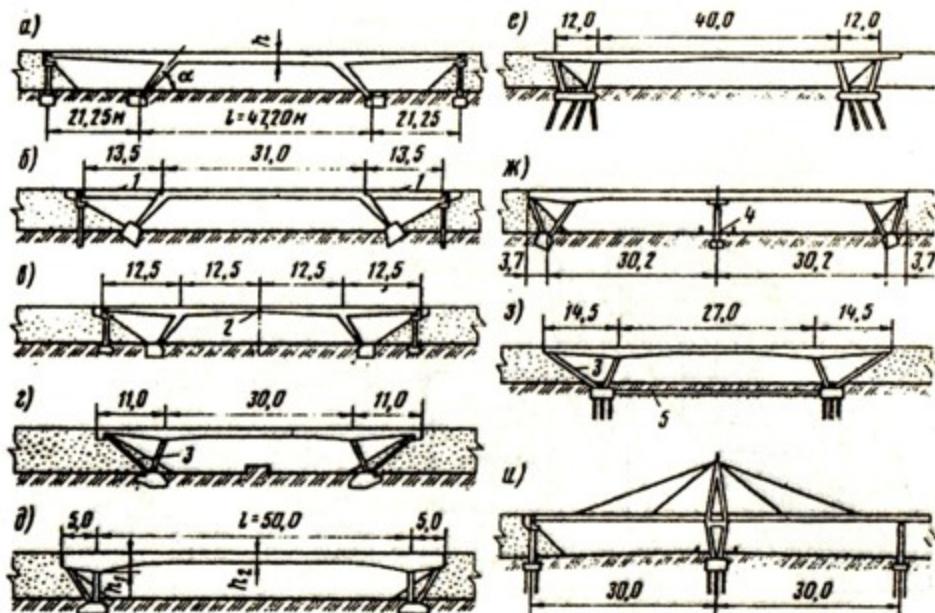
Схемы железобетонных путепроводов рамной и комбинированной систем:
